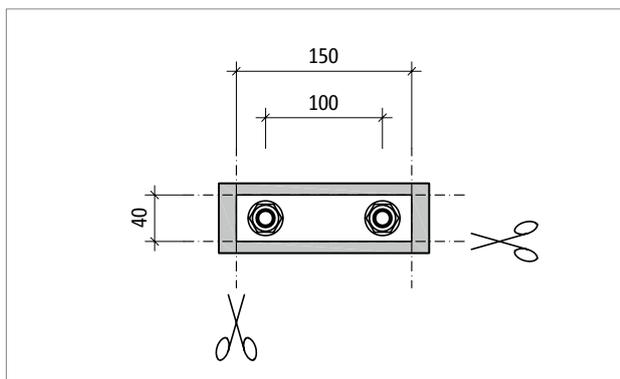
Schöck Isokorb® T Typ S-N: Maße nach Abschneiden des Dämmkörpers
